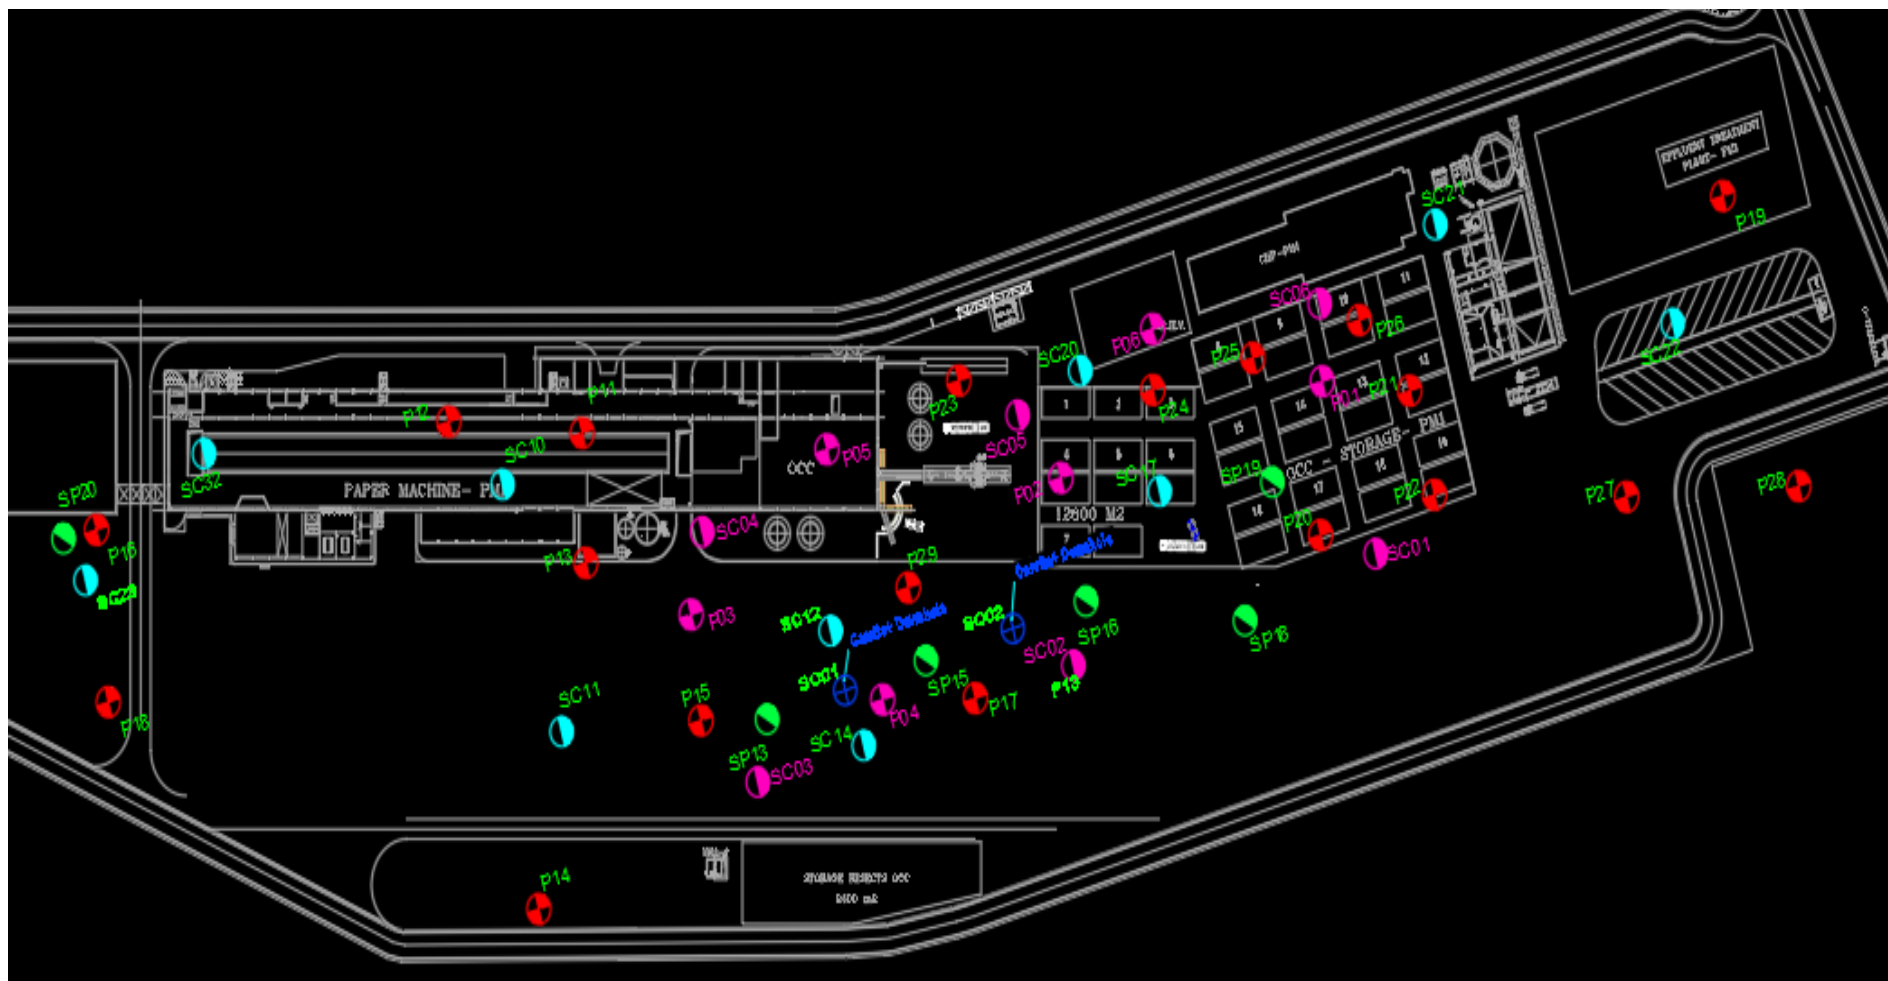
Plan d'implantation des points de reconnaissances(AUTOCAD).
